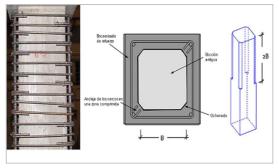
Encamisado de hormigón reforzado Fuente: Investigación
